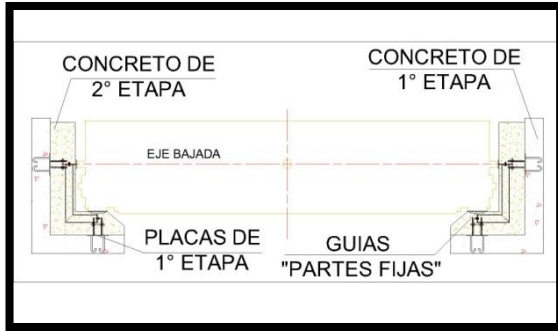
Sección transversal con placas de primera etapa y partes fijas. (Sección A-A)
